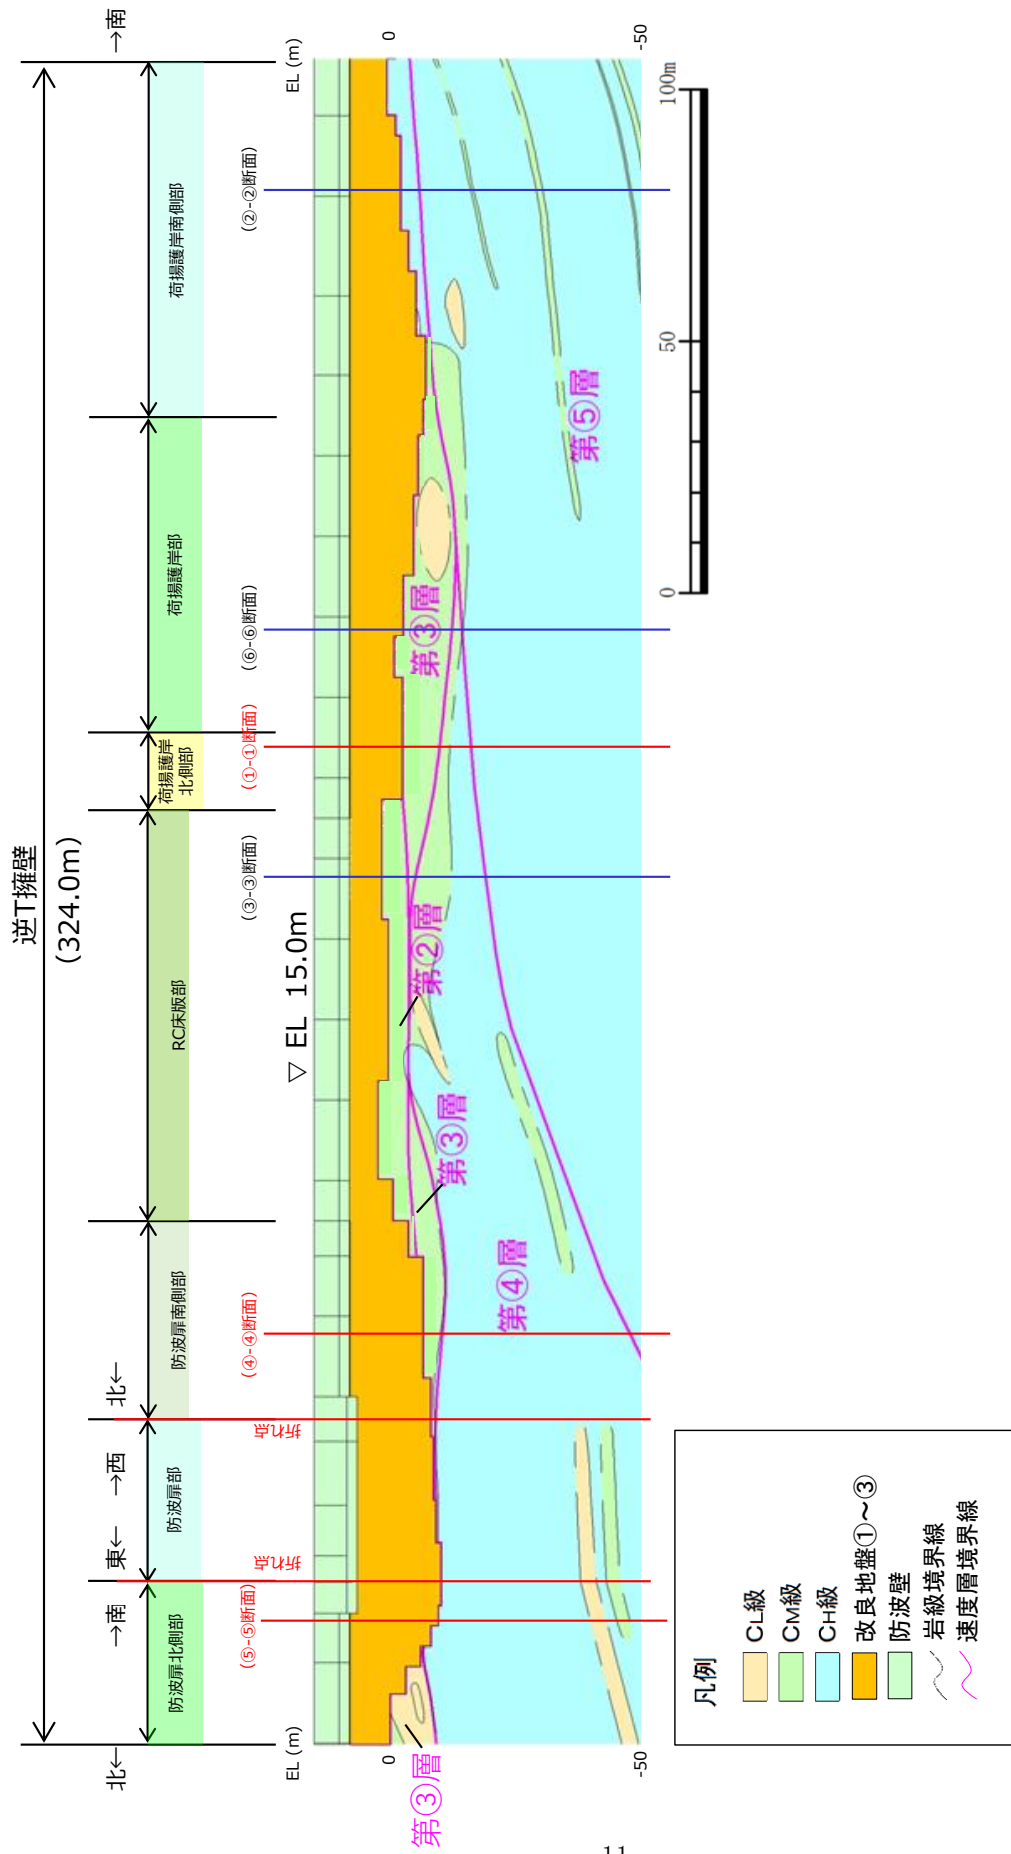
防波壁（逆 T 擁壁）の縦断面図
